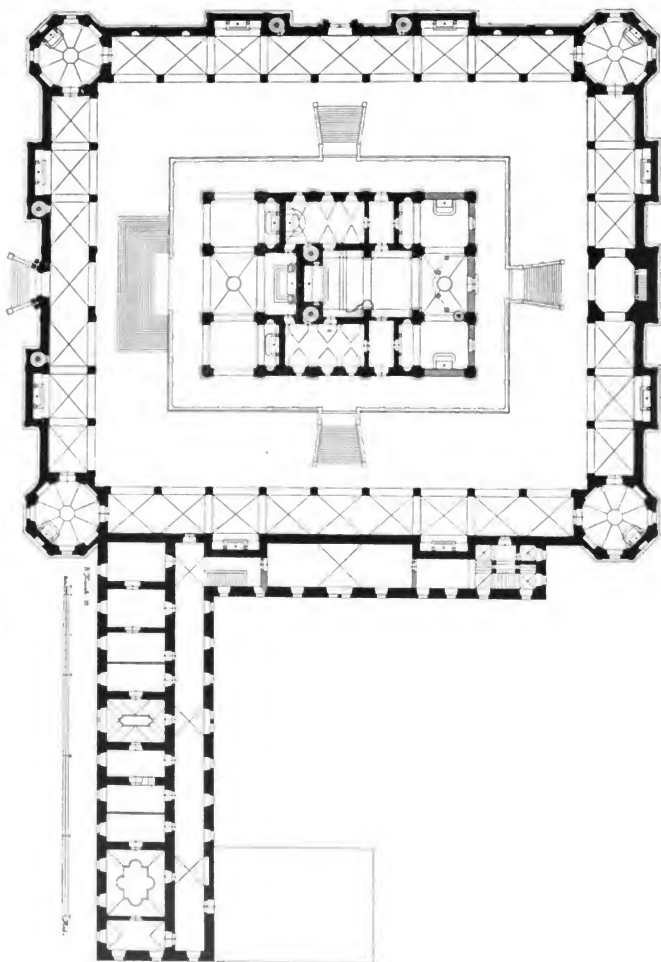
Pilsnam. Der Heilige Berg. Grundriss.
